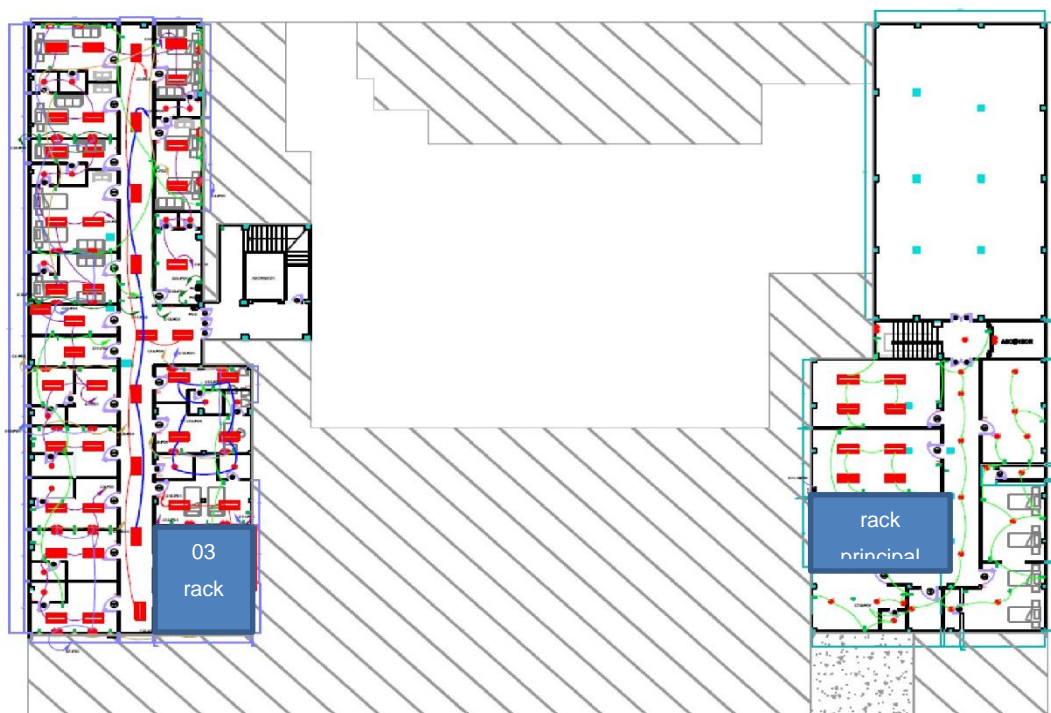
Ubicación de Rack en el bloque F planta baja.
